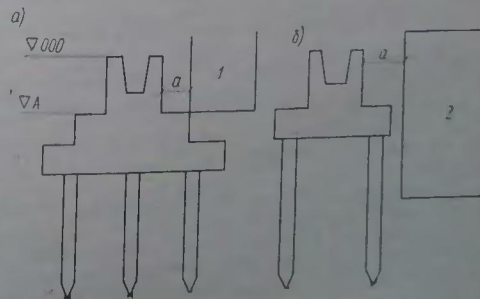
Схемы кустовых свайных фундаментов вблизи каналов 1 (а) и заглубленных помещений 2 (б)
